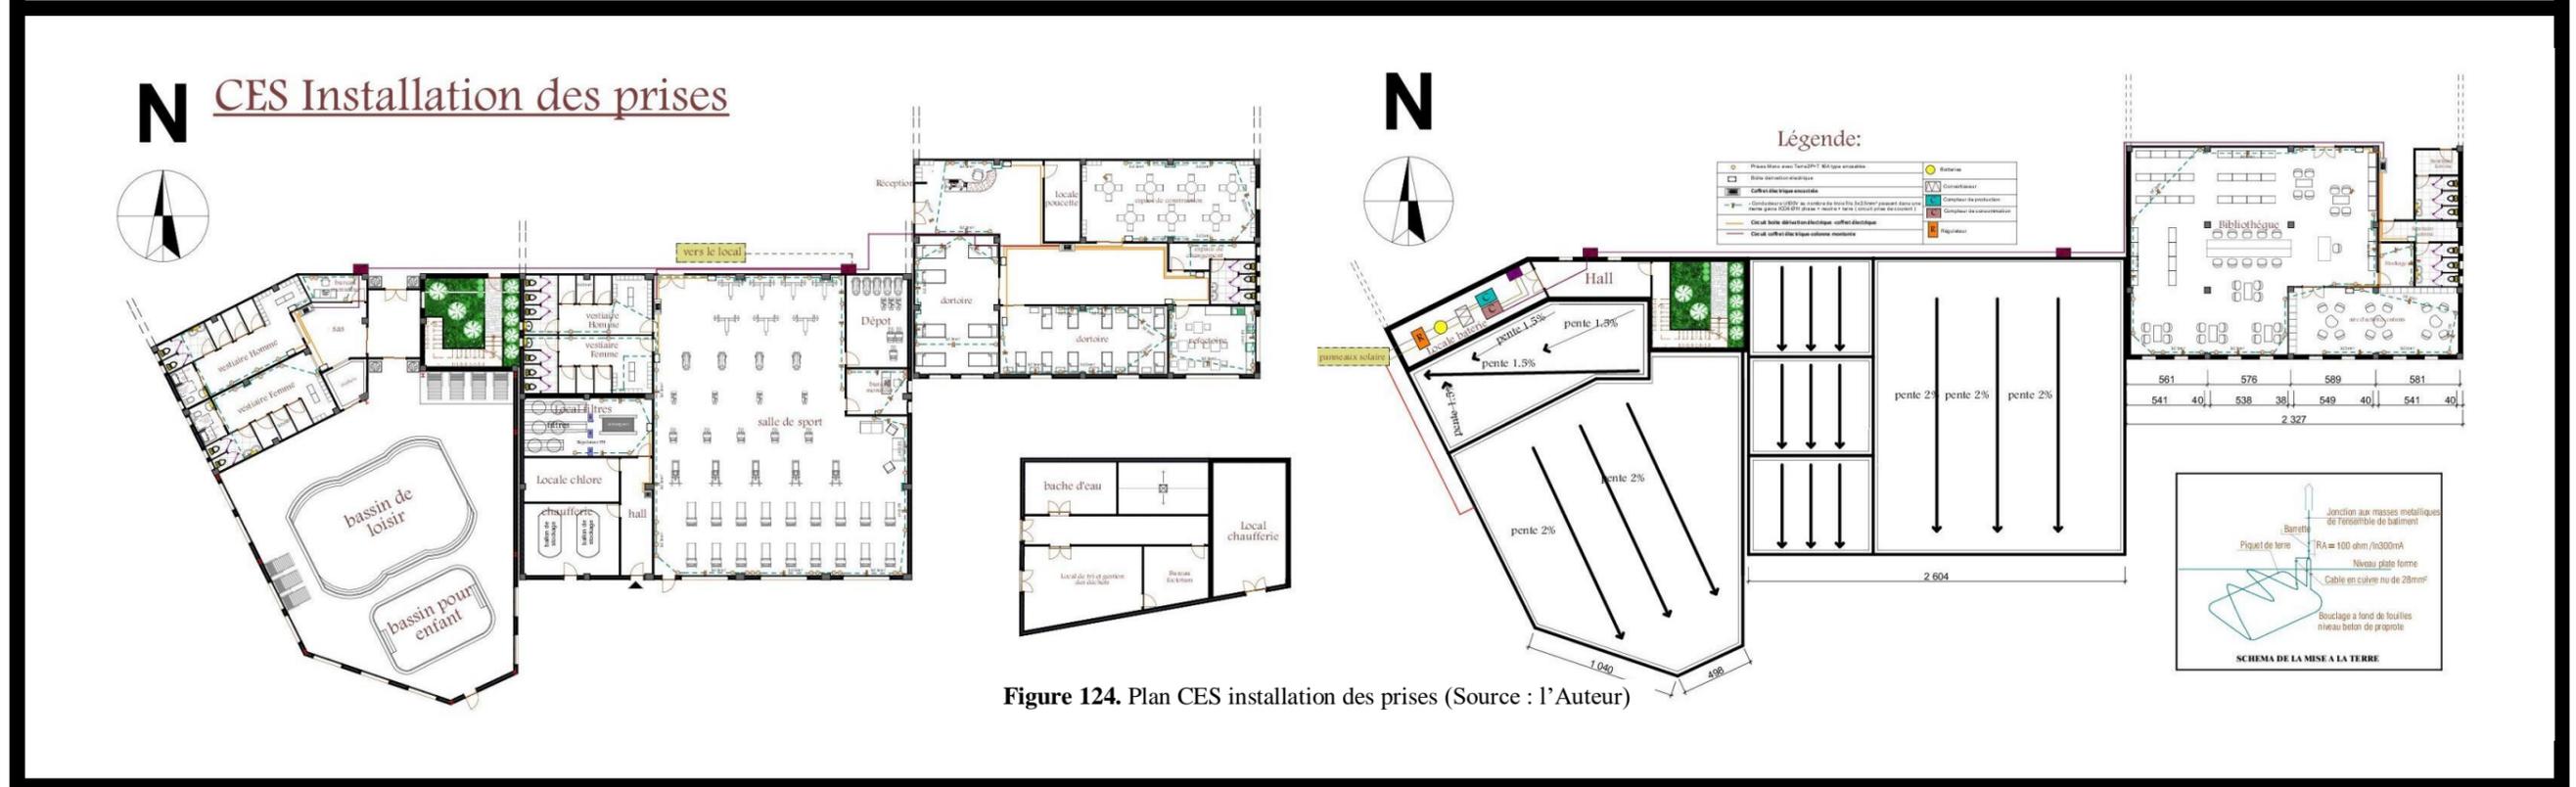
Plan CES installation des prises (Source : l'Auteur)
